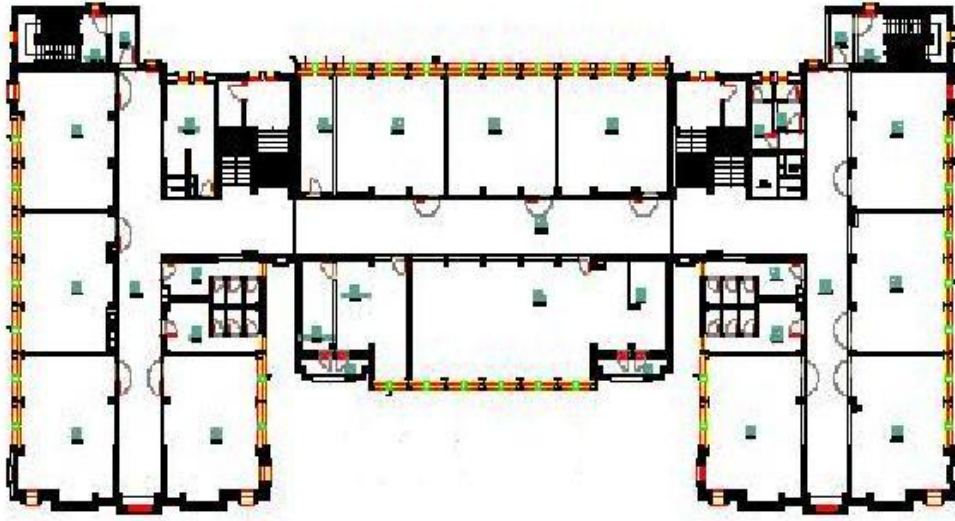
Alpaslan İ.Ö.O. 1.kat plan
